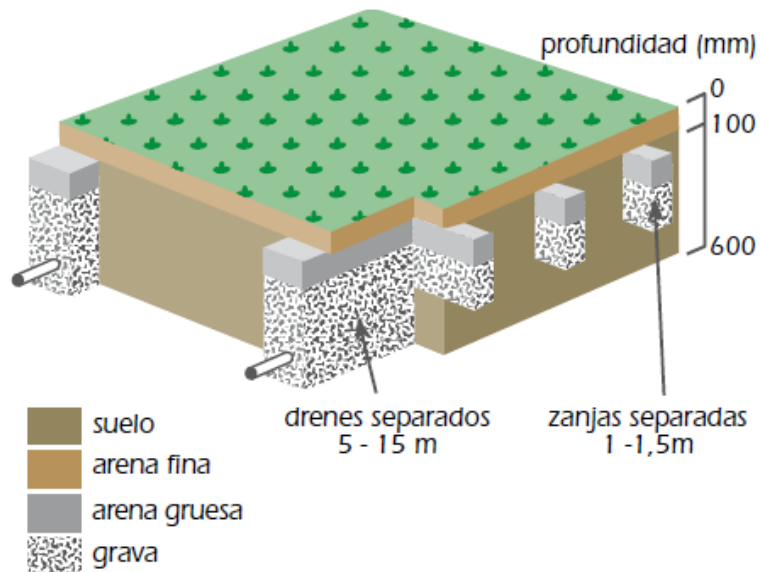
Detalle de un sistema tipo *slitdrain* en terreno original.
